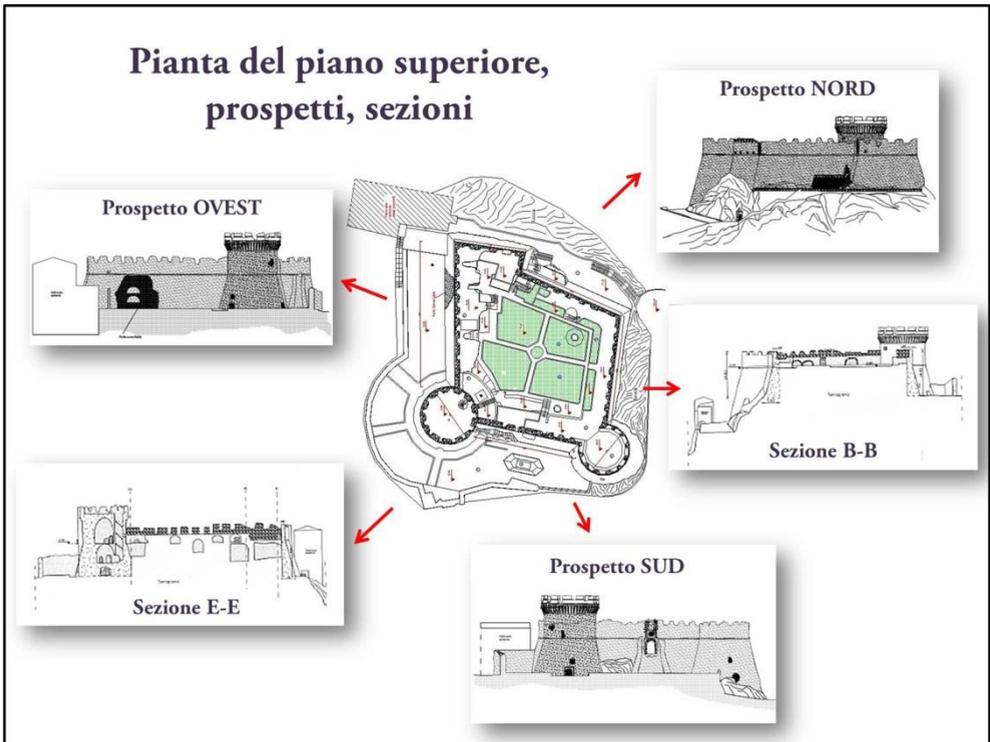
Il Castello di Belvedere: Pianta, prospetti, sezioni
